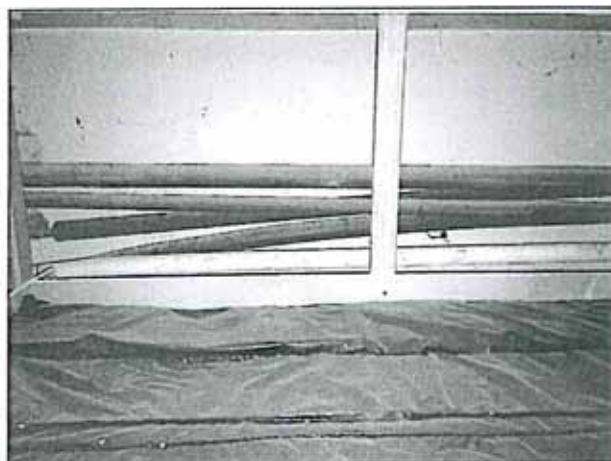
vista della controsoffittatura all'intradosso – locale Mensa (rif. Figura 1)
